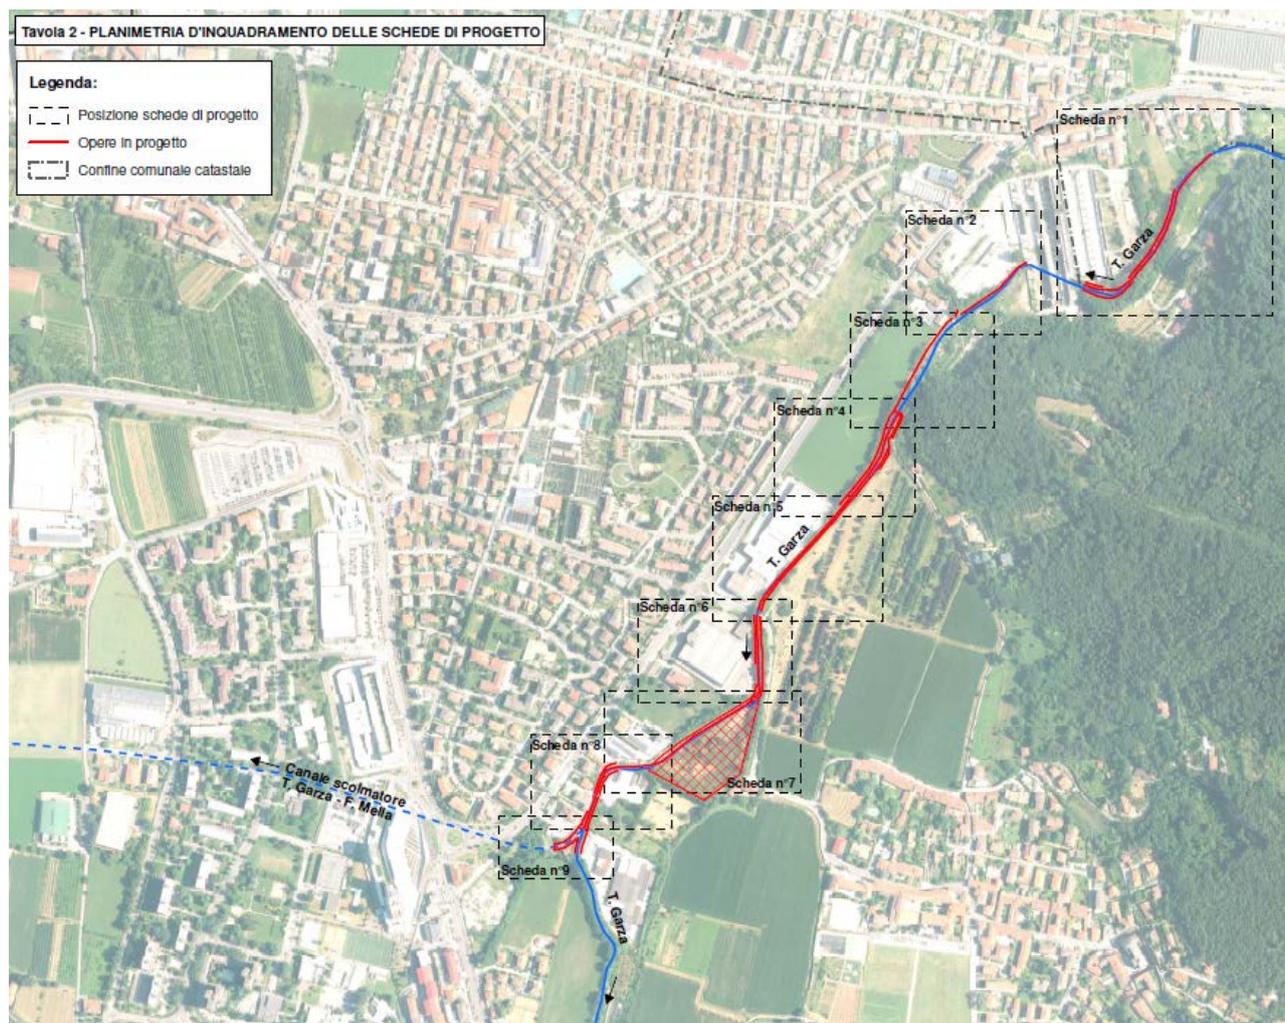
Estratto planimetrico del progetto preliminare Dicembre 2018 con sistemazione idraulica del torrente Garza.
